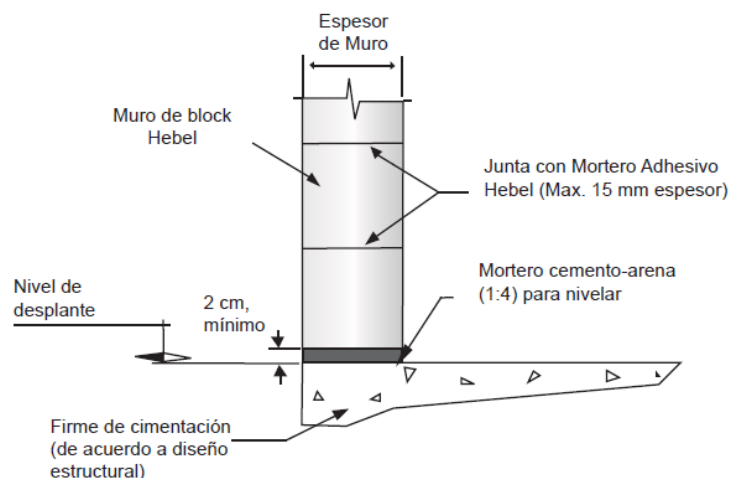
Corte del block de concreto celular curado en autoclave Hebel, y su aplicación. Siendo sujetos de estudio a cargas verticales y laterales.
